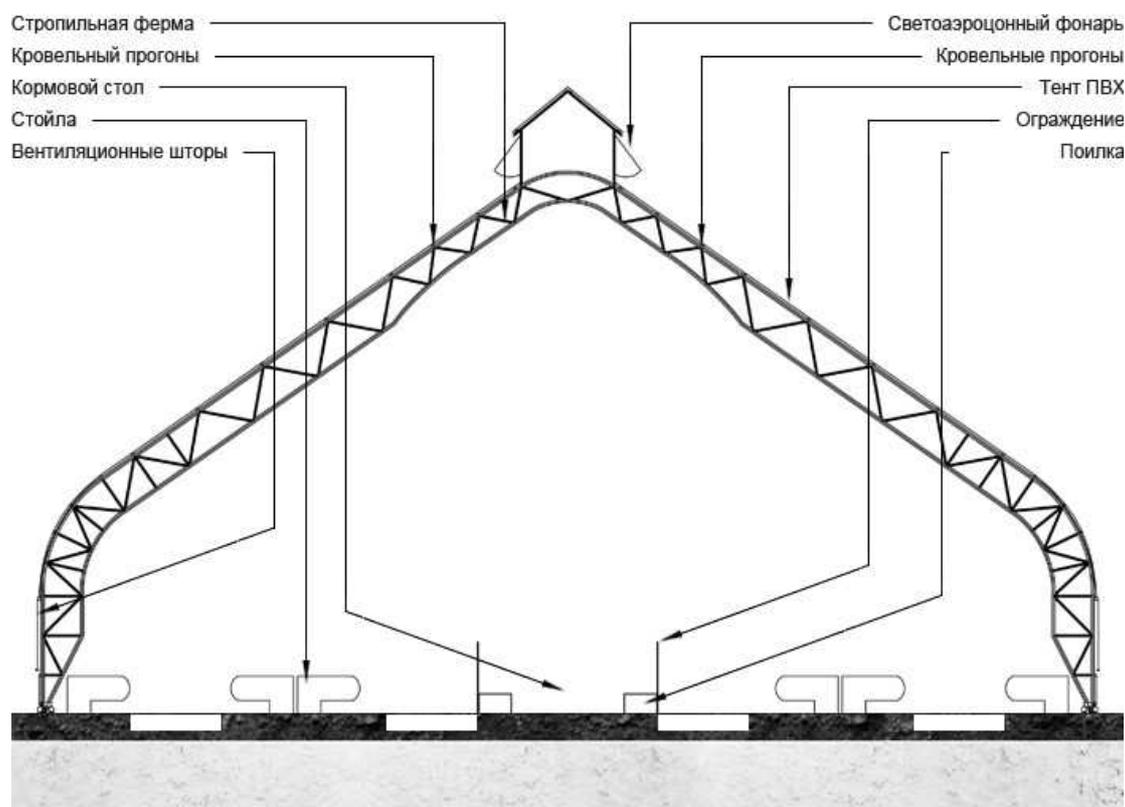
Широкогабаритный каркасно-тентовый коровник из металлических конструкций
